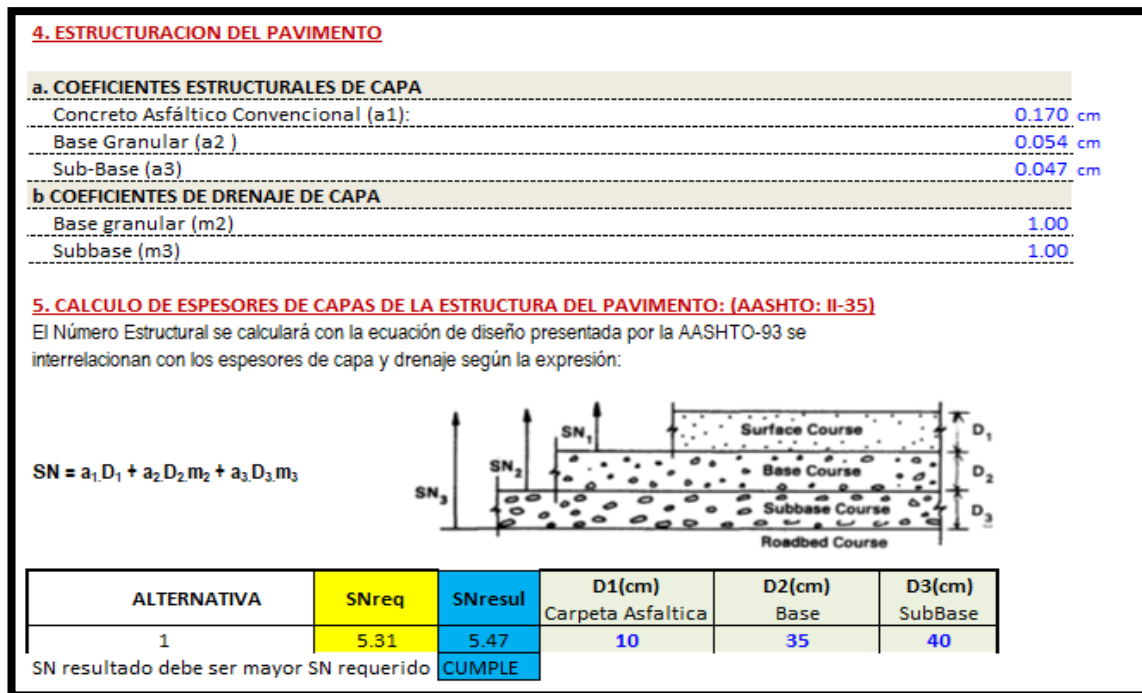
Estructuración del pavimento flexible (con geomalla biaxial bx3030)
